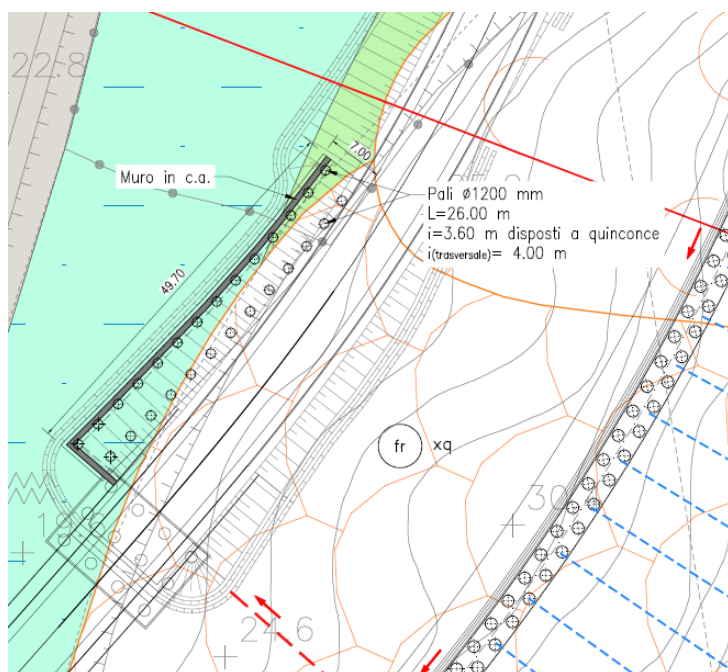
Stralcio planimetrico muro su rilevato stradale
